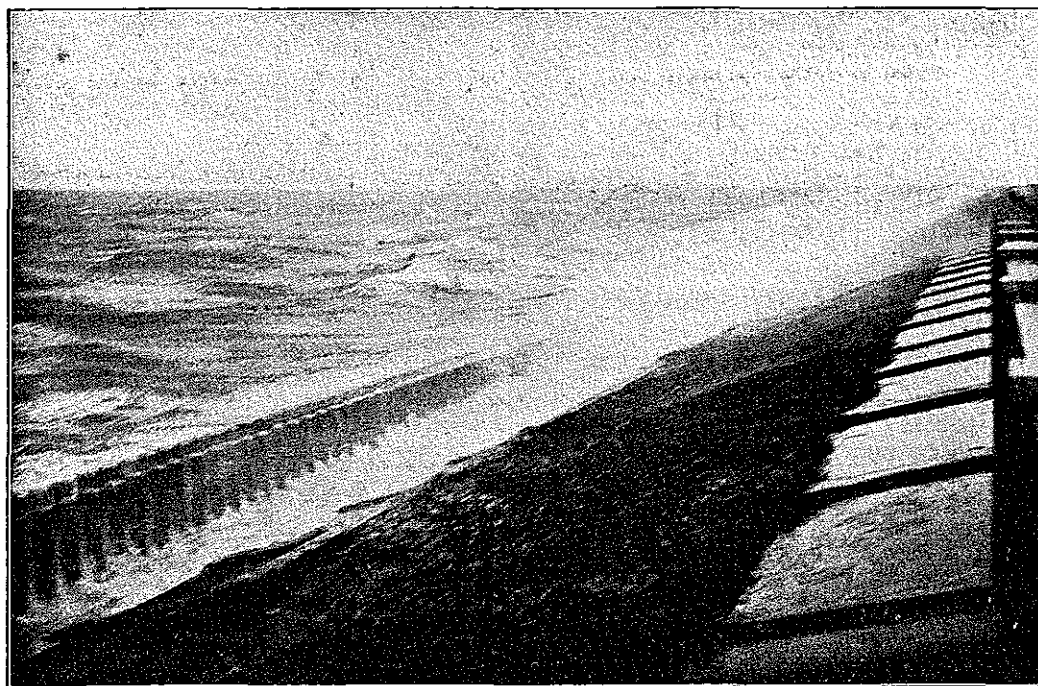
Betonglooiing, betonmuur en betonpaalwerk aan den Langendijk van Schouwen
